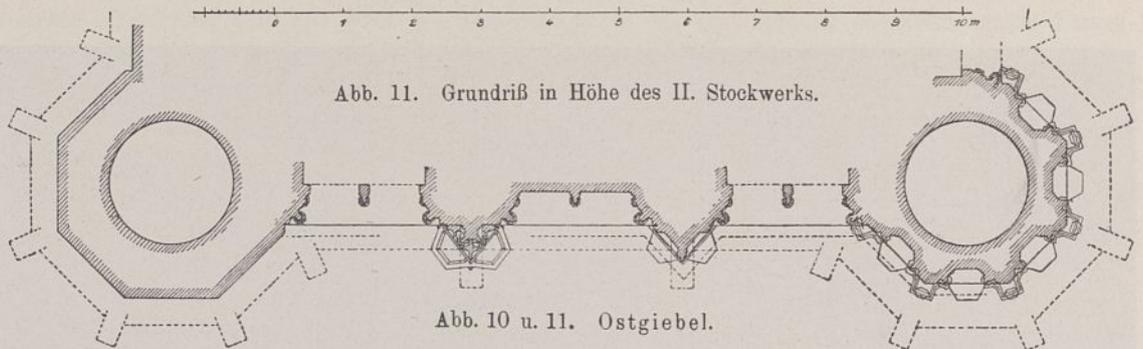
Grundriß in Höhe des II. Stockwerks.
